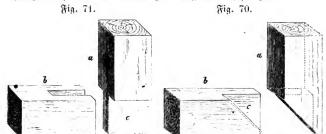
zeigt ben Berband einer stumpf zusammengeschlißten Ede. Häusig wird bas Holzstüd b mit zwei und mehreren Schligen versehen, je nach seiner Dide, in welche eben so viele Zapsen passen, welche an bas Holzstüd a gearbeitet werben. Auch werben die Zapsen zuweilen an ber in eneren Seite abgesetzt, wo bann bie Schlige weniger tief in bas andere Holzstüd eingeschnitten werben.
